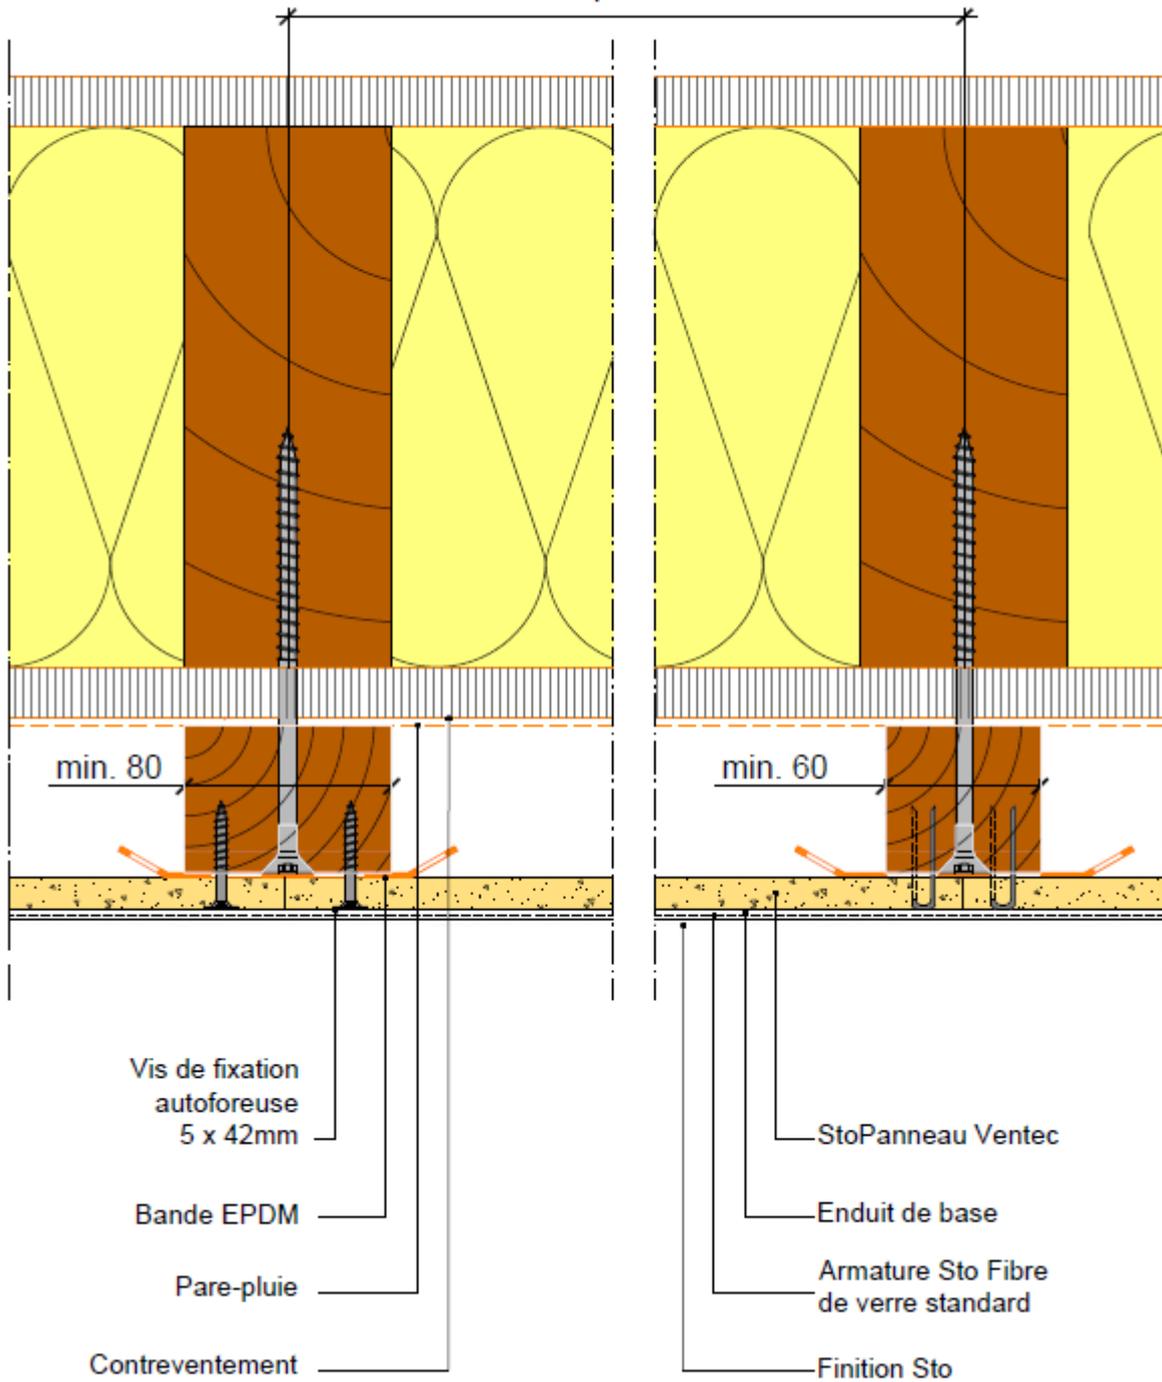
Coupe horizontale - Ossatures bois sur COB
